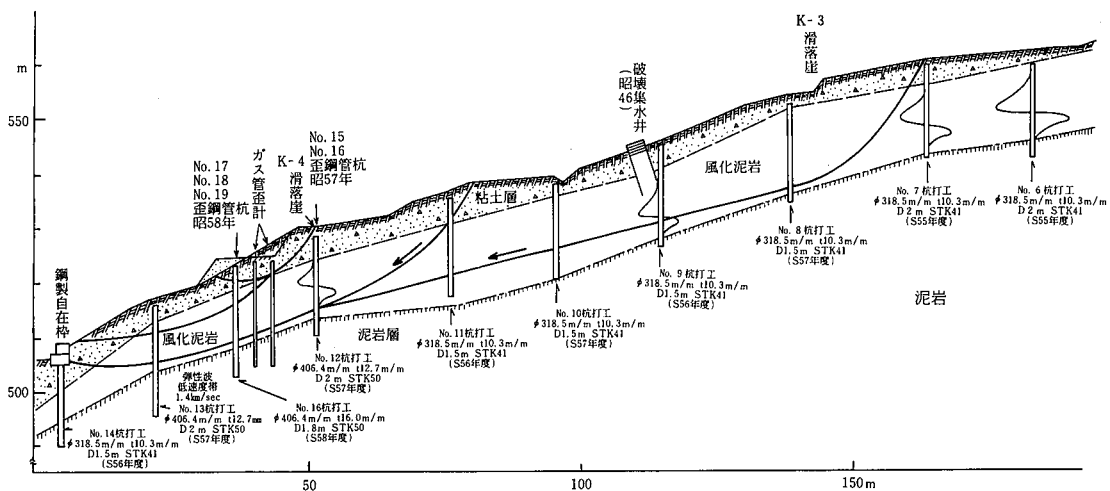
土質累重，防止杭，歪杭等配置縦断面図
